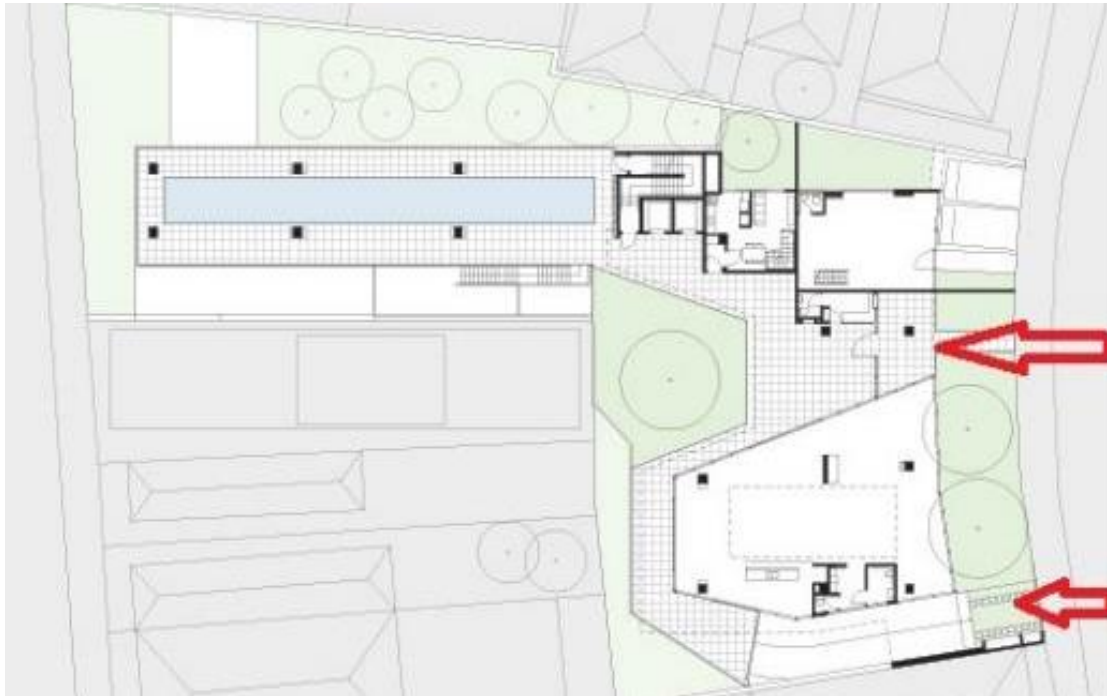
Planta de acceso por la Rua Madalena. Planta editada a partir de la planta elaborada por Andrade Morettin Arquitetos (2016).
